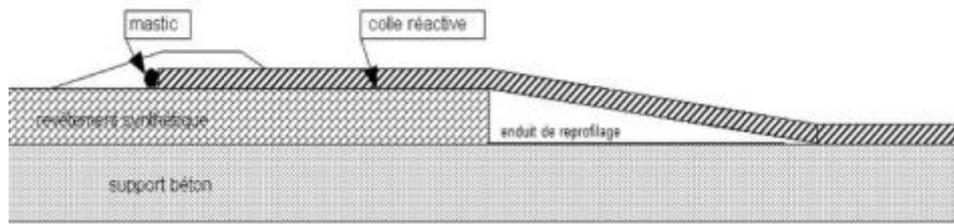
Schéma de mise en œuvre du raccordement entre les dalles GTI MAX CONNECT et un revêtement synthétique
